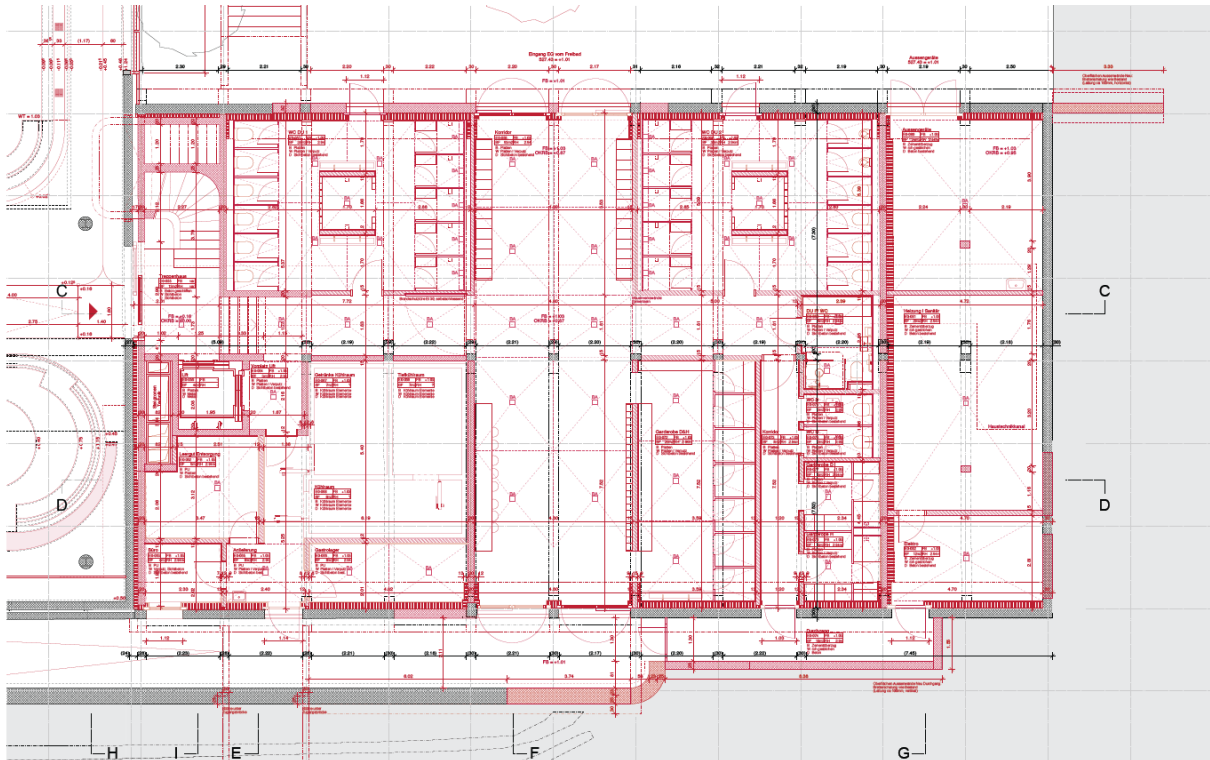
Pläne Erdgeschoss – – Bildnachweis – GFA Gruppe für Architektur GmbH
